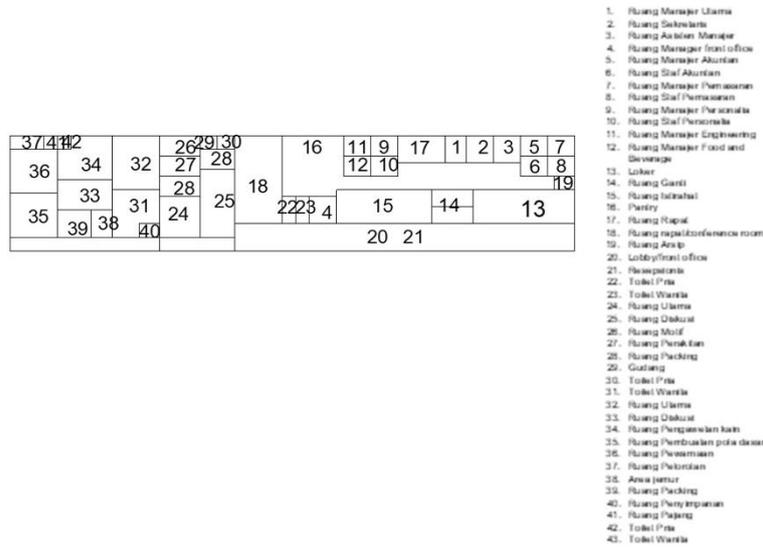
Bubble Plan Gedung Co-working lantai 3
